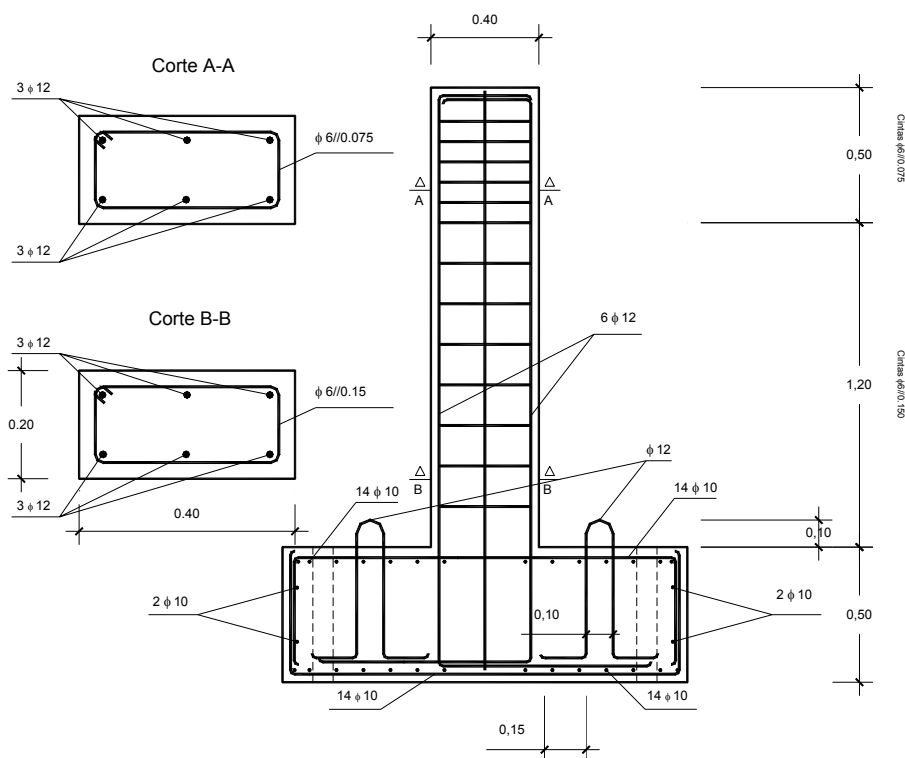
Pormenores da armadura do modelo PA1 (dimensões em m).
